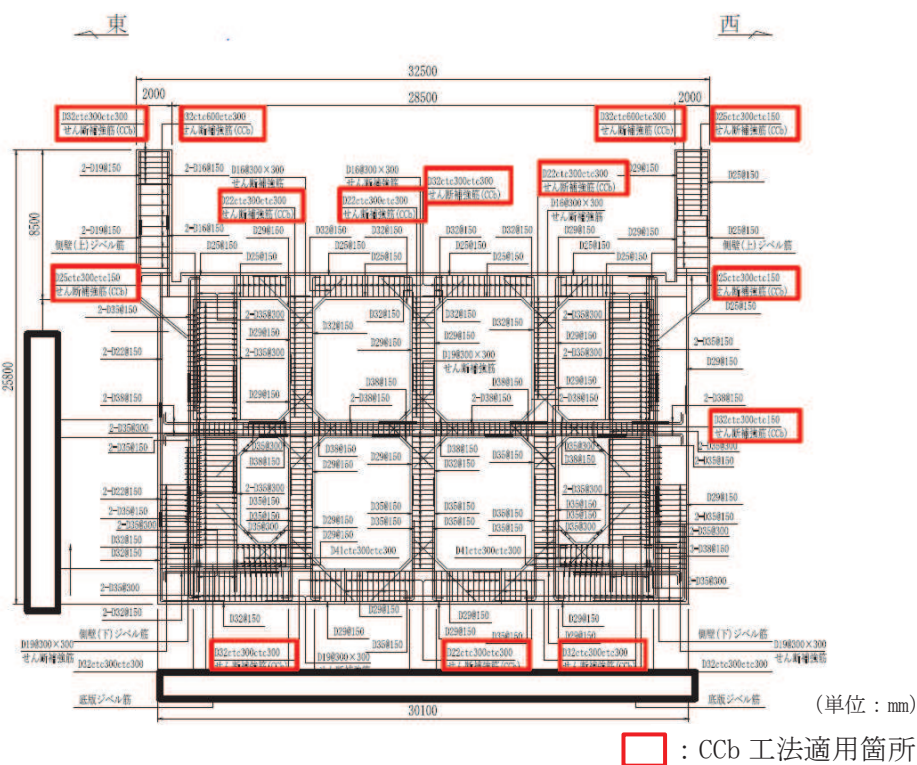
海水ポンプ室概略配筋図 (A-A 断面, 東西 (スクリーンエリア))
